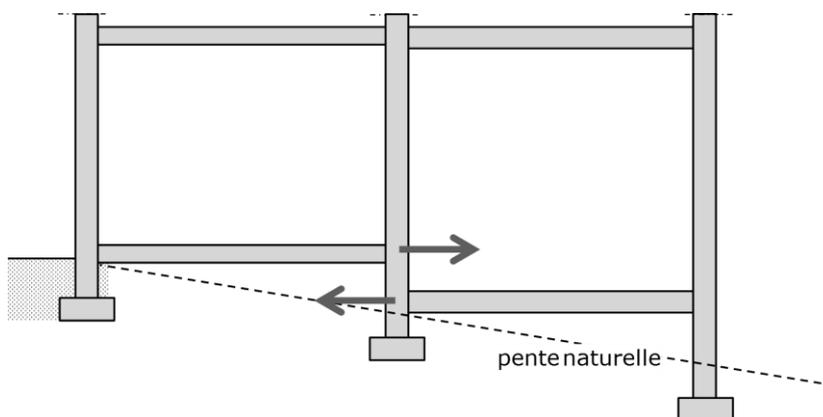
sollicitations supplémentaires sur les bâtis mitoyens dont les planchers sont décalés
